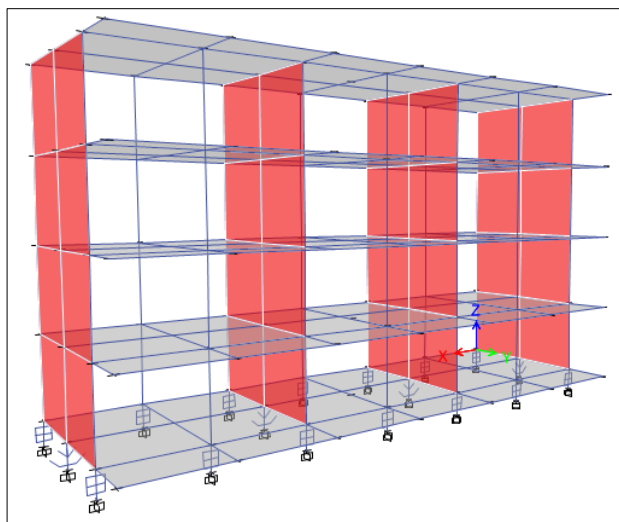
Vista conjunta frontal y lateral del modelo estructural 3D con aislación
